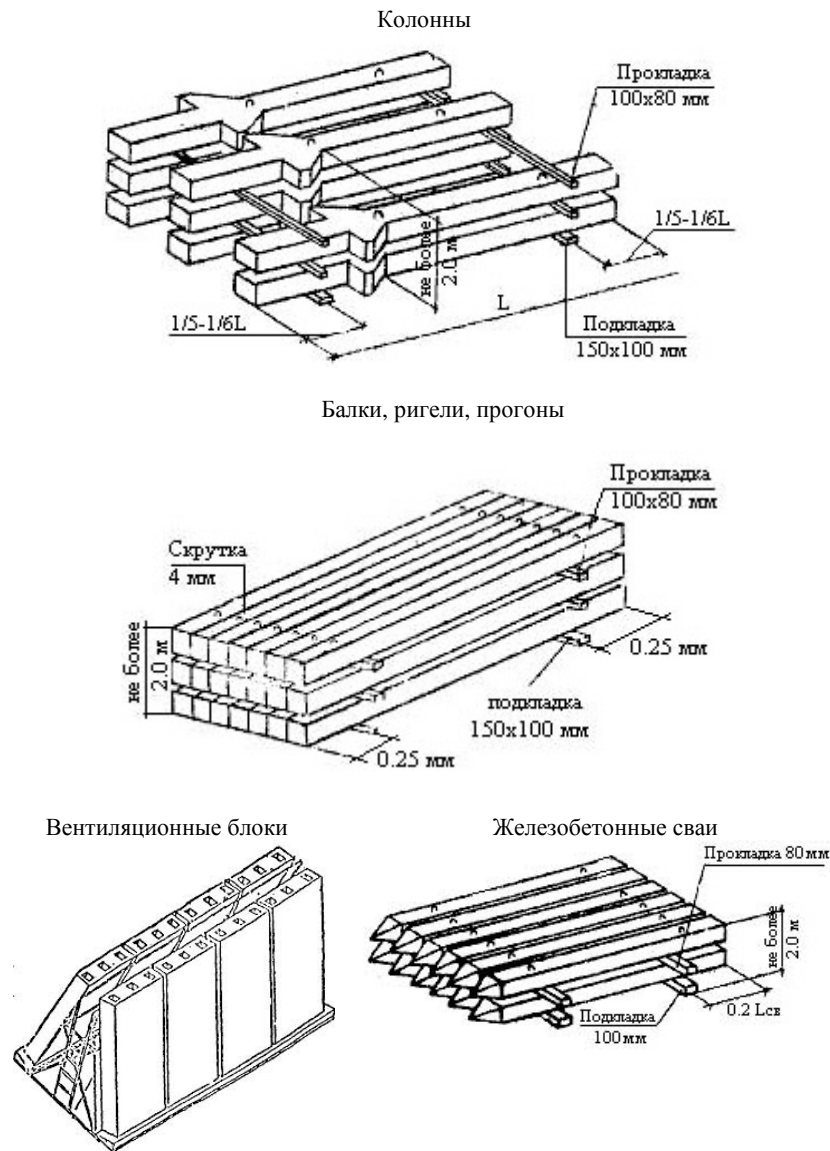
Схемы размещения на складе железобетонных изделий (окончание на с. 65)
